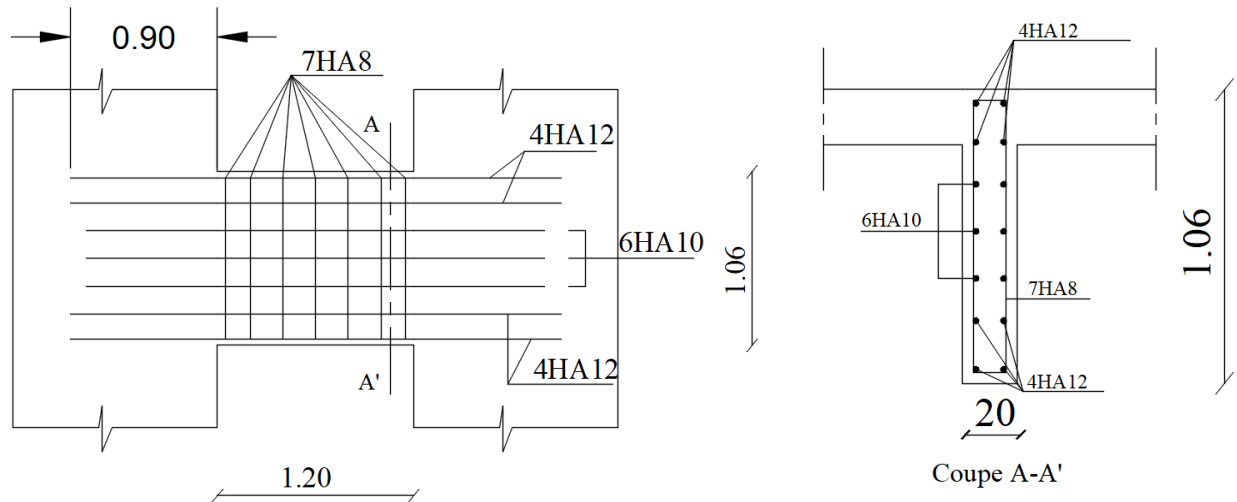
Schéma de ferrailage du linteau VL4.
